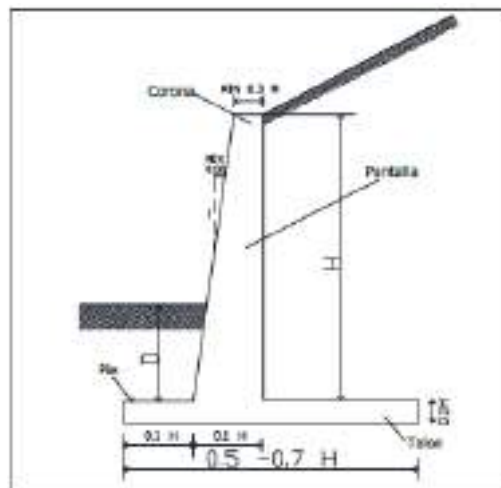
Predimensionamiento de Muro en Voladizo en Principios de la Ingeniería de Cimentaciones. Das (2000)
